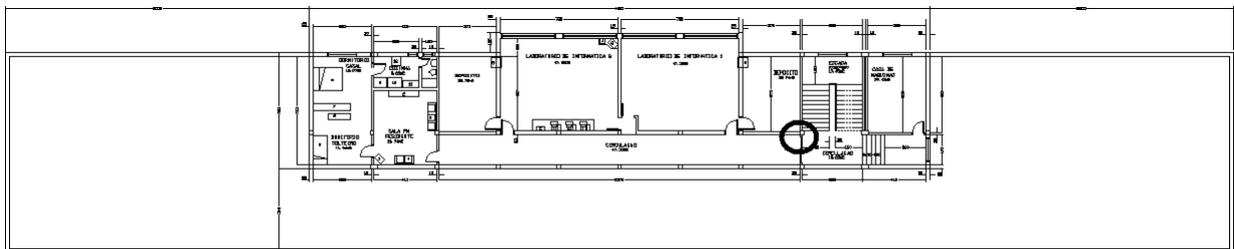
Localização sugerida para o acionador do sistema de alarme de incêndio no quinto pavimento.
